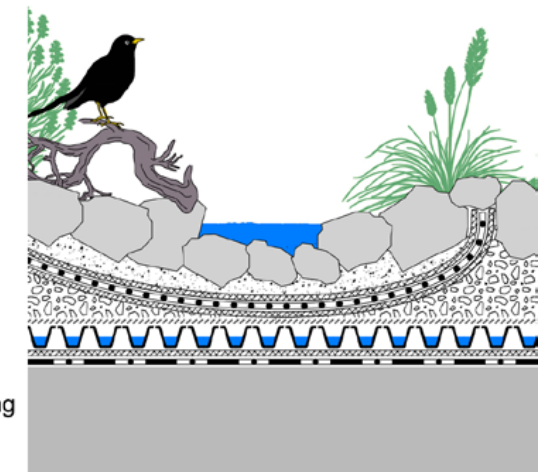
Systemaufbau - Biodiversität Dach mit temporären Wasserflächen
